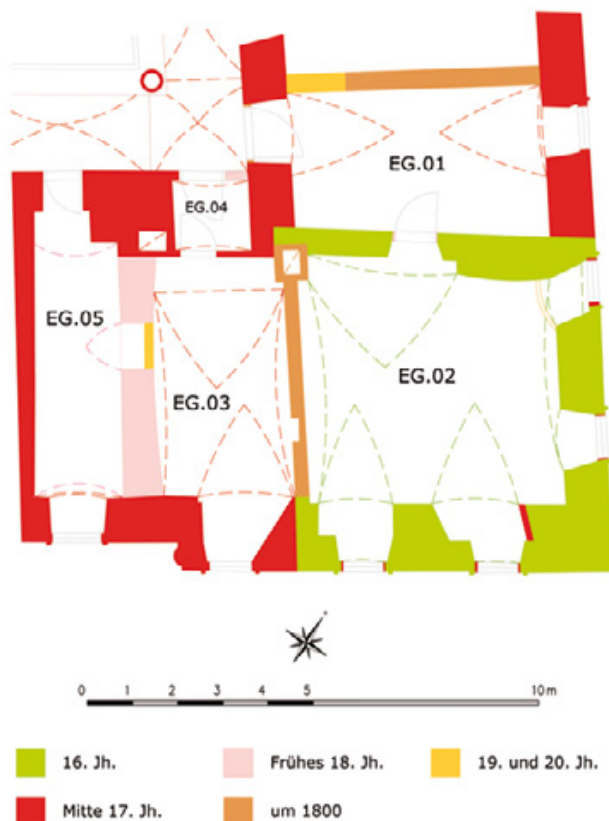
Pitten, Pfarrhof. Bauphasenplan des Erdgeschoßes im Untersuchungsbereich.
